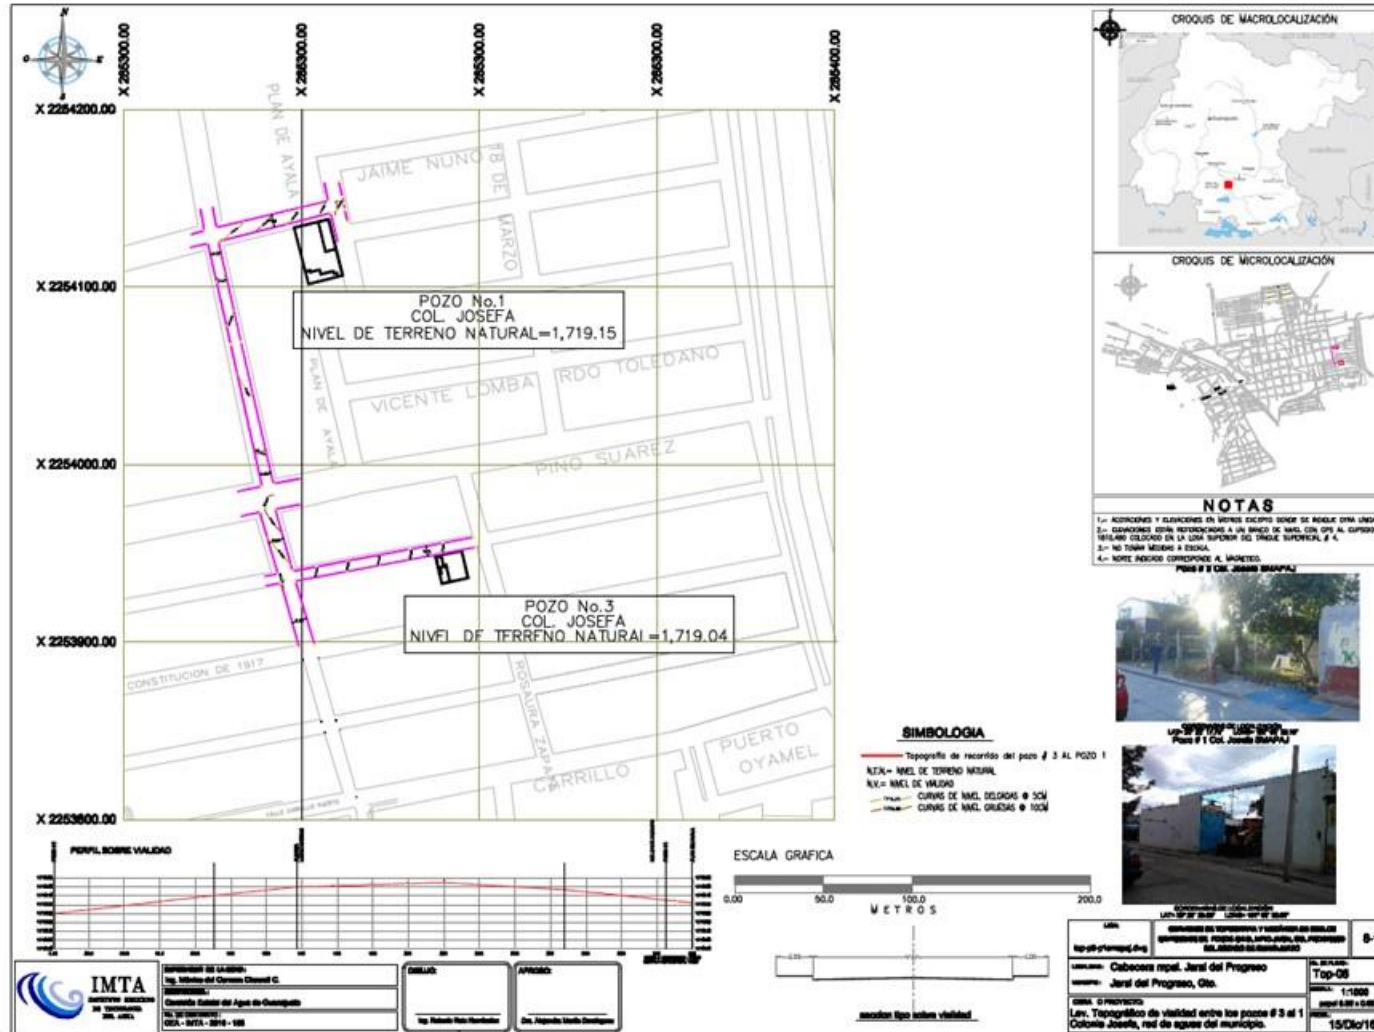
Levantamiento vialidad entre Pozo 1 y Pozo 3 (Ver anexo de planos para más detalle)
